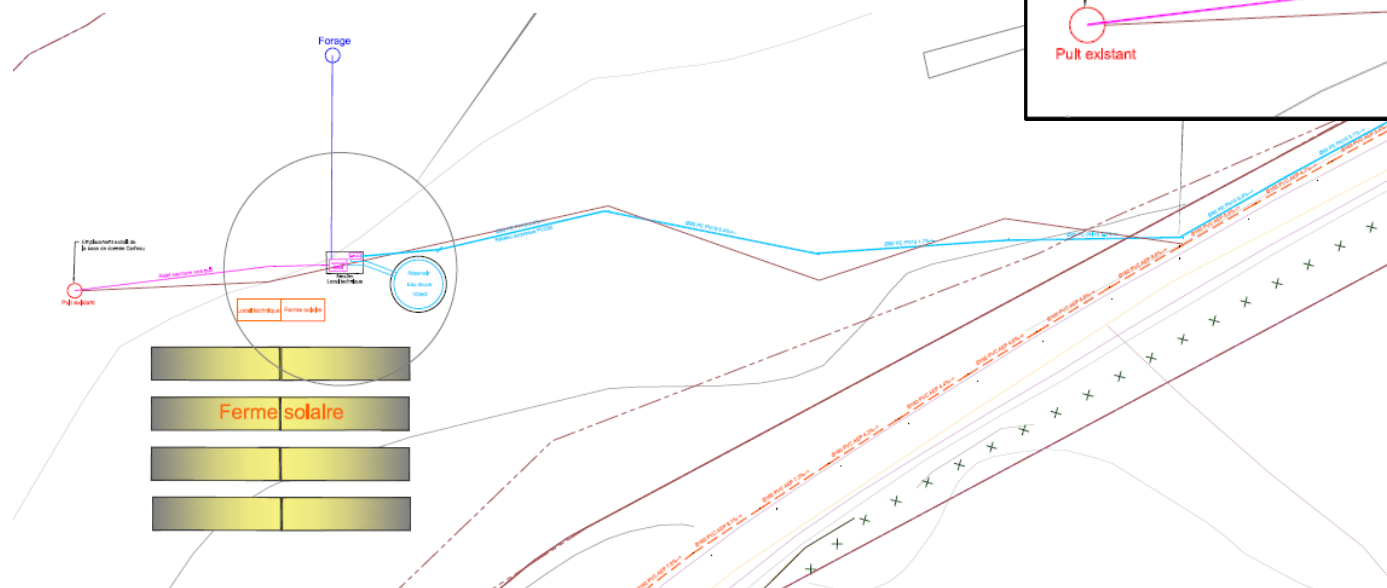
Plan masse du projet d'unité de dessalement de Lebris (Source : Eau NC)
